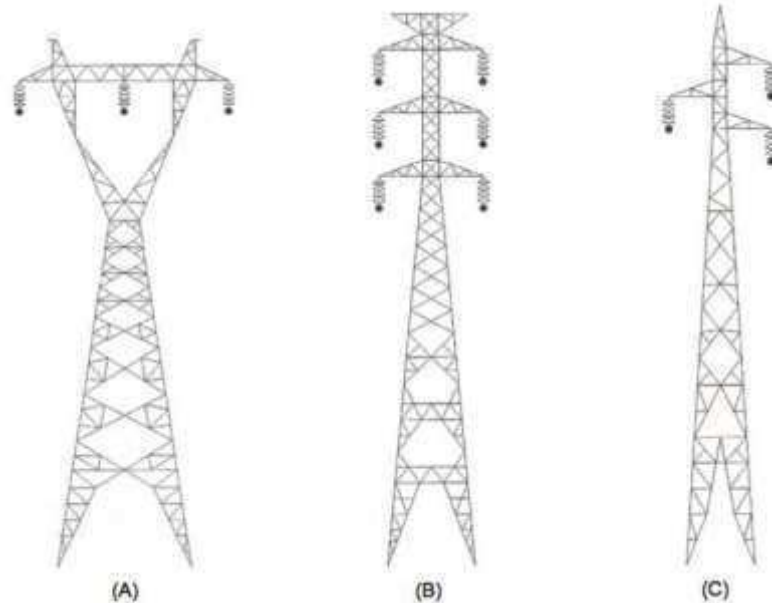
Disposição dos condutores: (A) em plano horizontal; (B) em plano vertical; (C) triangular (GONTIJO, 1994).
